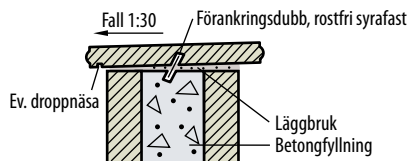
Avtäckning på dubbelsidig beklädnadsmur.
